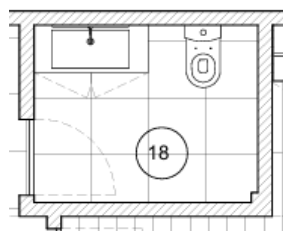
Instalação sanitária de serviço 3, excerto da planta de apresentação
